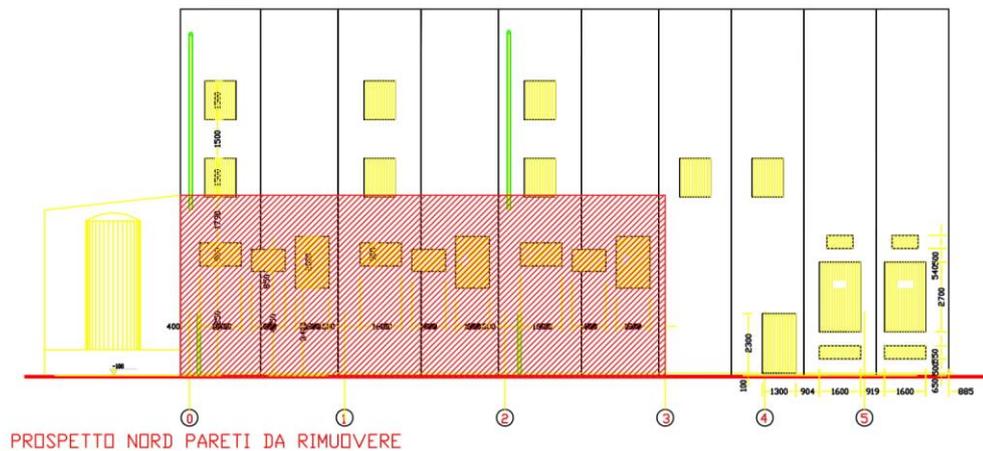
Impianto BL1 – Prospetto con moduli da rimuovere
